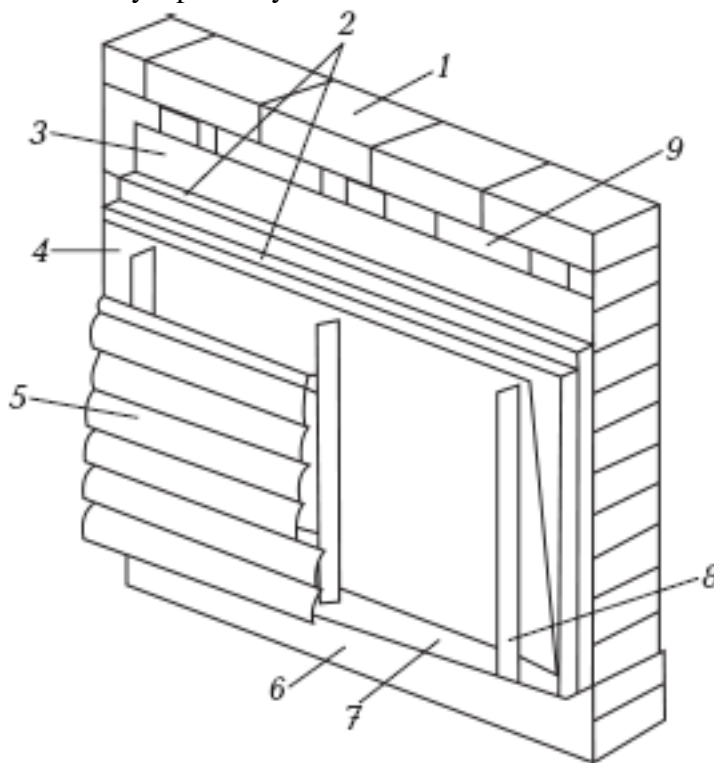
Монтаж навесного вентилируемого фасада на деревянном каркасе: 1 – наружная стена; 2 – утеплитель (два слоя минеральной ваты); 3 – пароизоляция; 4 – ветрозащита; 5 – сайдинг; 6 – стартовая планка; 7 – вентиляционная решетка, защищенная сеткой; 8 –
